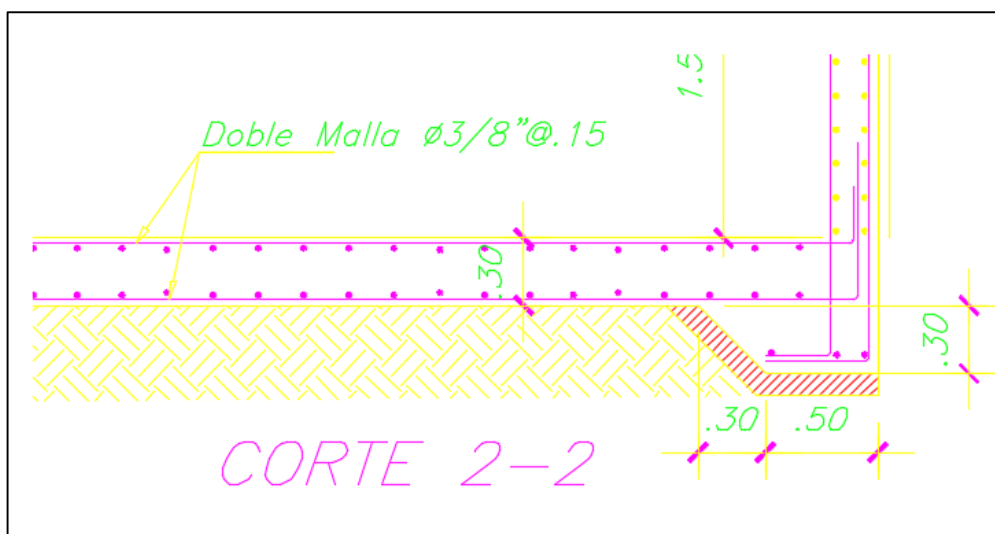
Detalle de armadura de acero en losa de cimentación en el tanque ecualizador.
